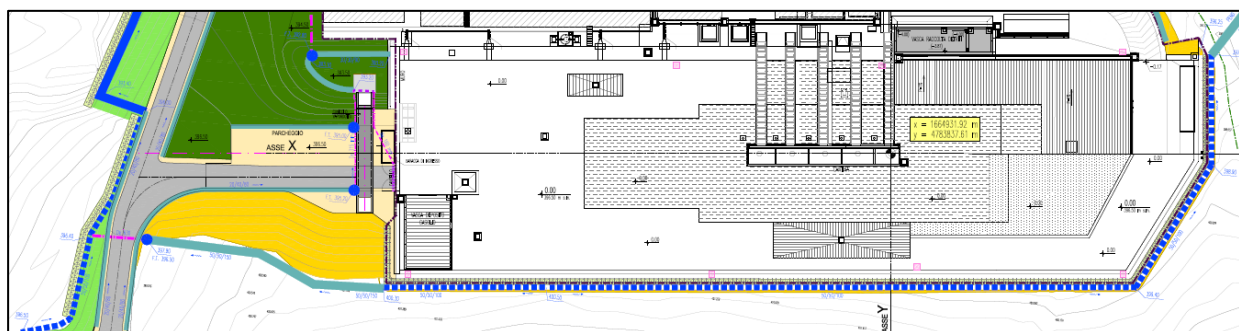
Planimetria di progetto della rete idraulica di intercettazione ed allontanamento delle acque esterne alla postazione (stralcio canalette in calcestruzzo e fossi in terra ubicati lungo il perimetro sud della postazione).
